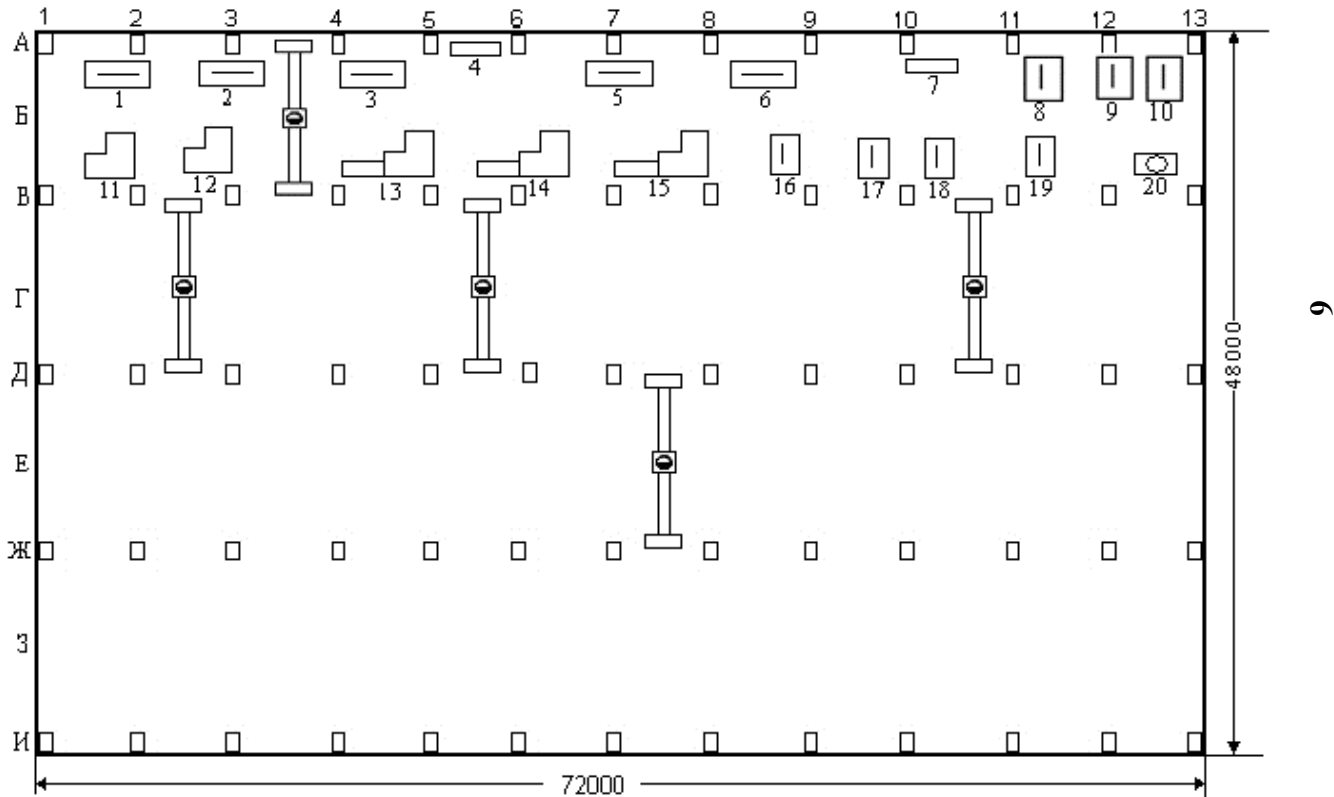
Схематичний план арматурно-зварювального цеху.
